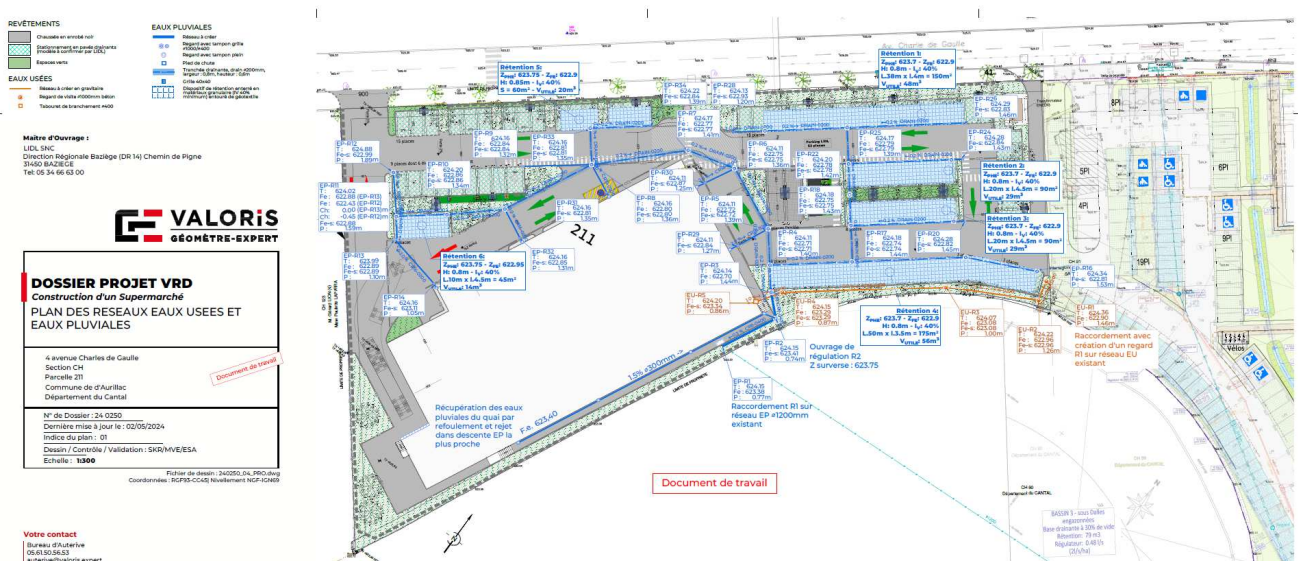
Plan des ouvrages de gestion des eaux pluviales (adapté de : Séquences, 2024)
